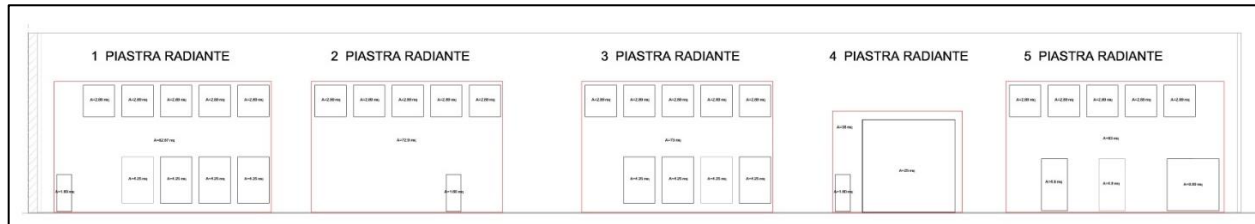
Prospetto Sud edificio N7 -bersaglio N4 N8
